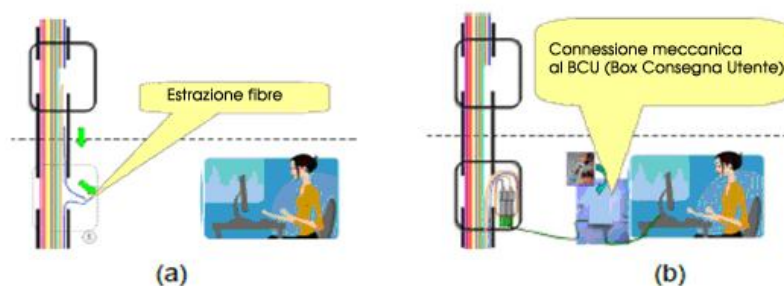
(a) estrazione delle fibre dal cavo; (b) giunzione e terminazione del cavetto orizzontale
